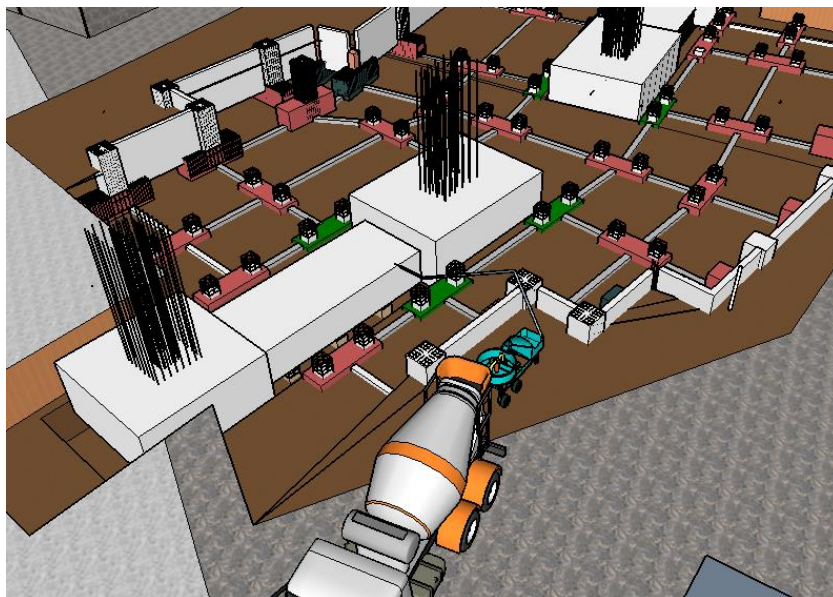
Render de cimentación de pilonas G4 culminadas
